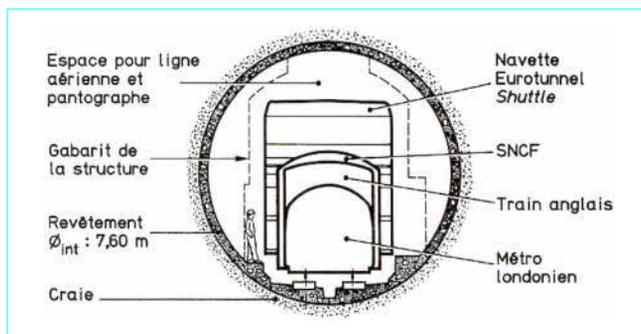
Section transversale du tunnel sous la Manche : comparaison avec d'autres gabarits courants
